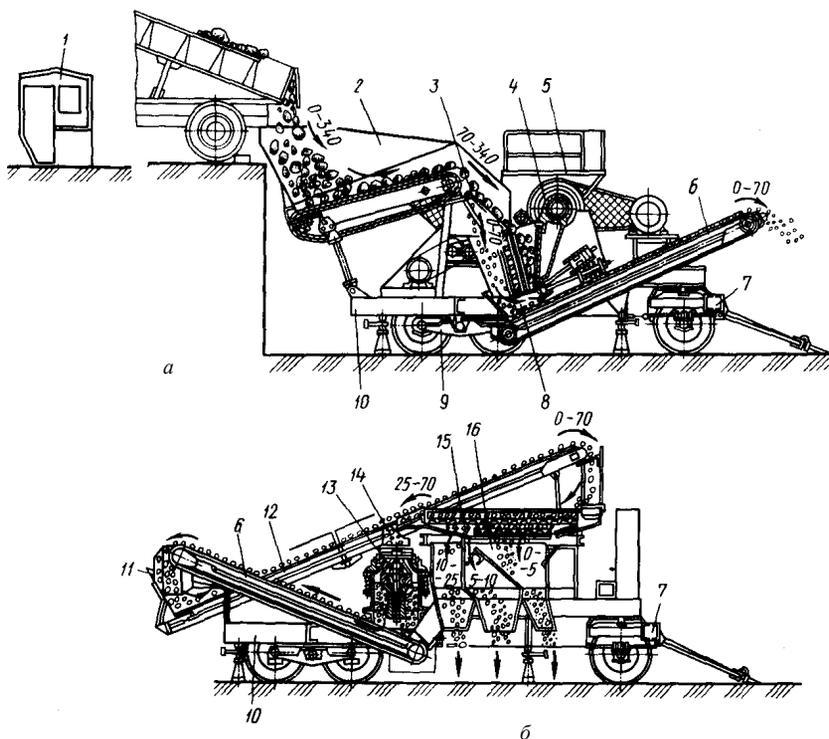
Схема агрегатов первичного и вторичного дробления передвижной установки: *а* – агрегат первичного дробления СМД-126; *б* – агрегат вторичного дробления СМД-127
